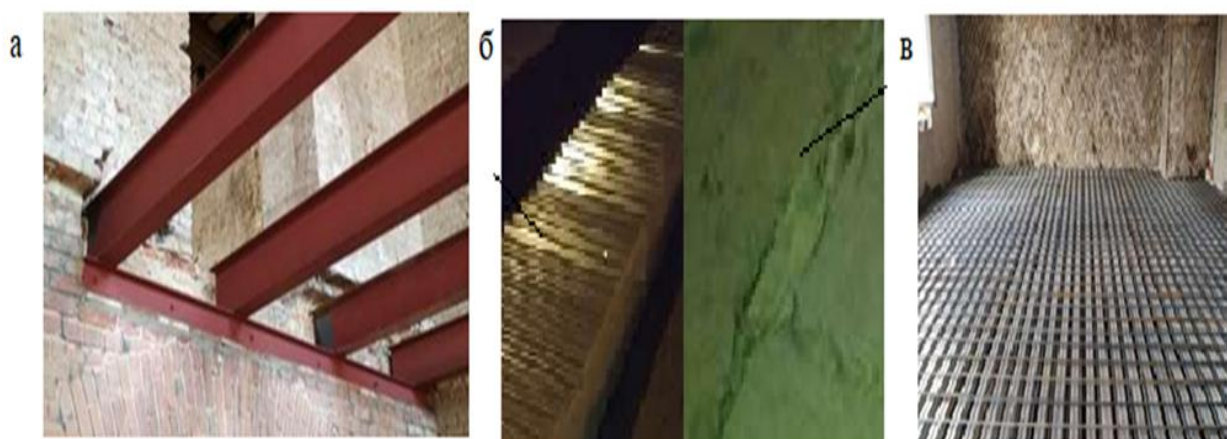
Последовательность работ по устройству перекрытия методом облегчённой конструкции:
